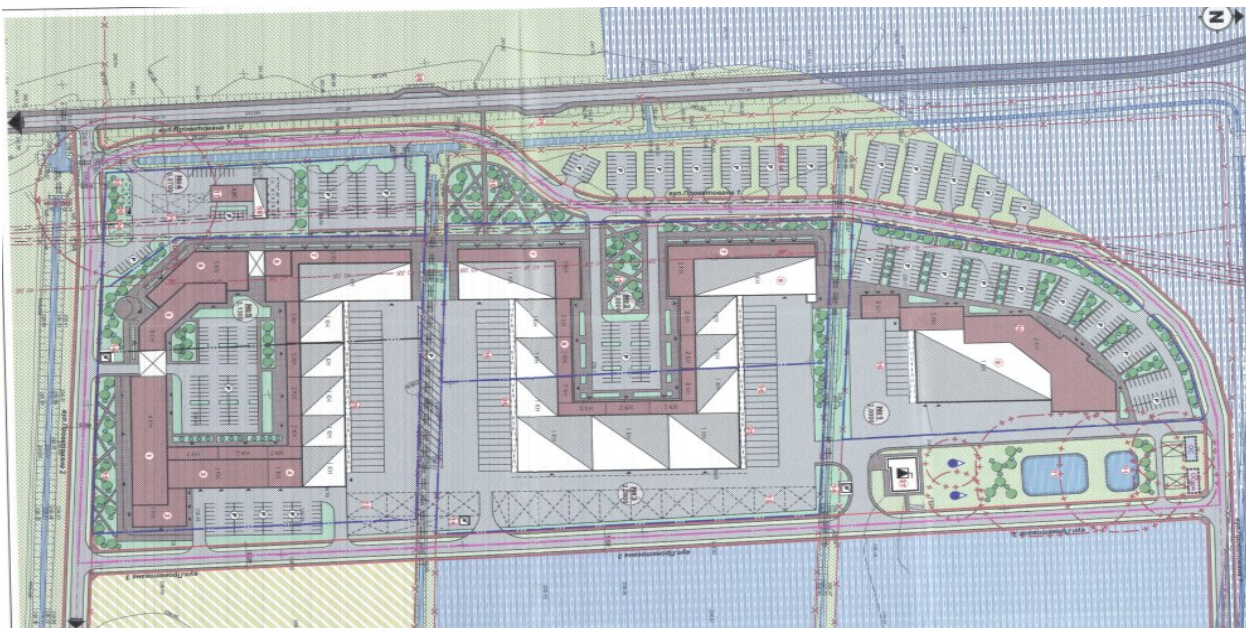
Проектний план поєднаний із схемою планувальних обмежень (М 1:1000)
